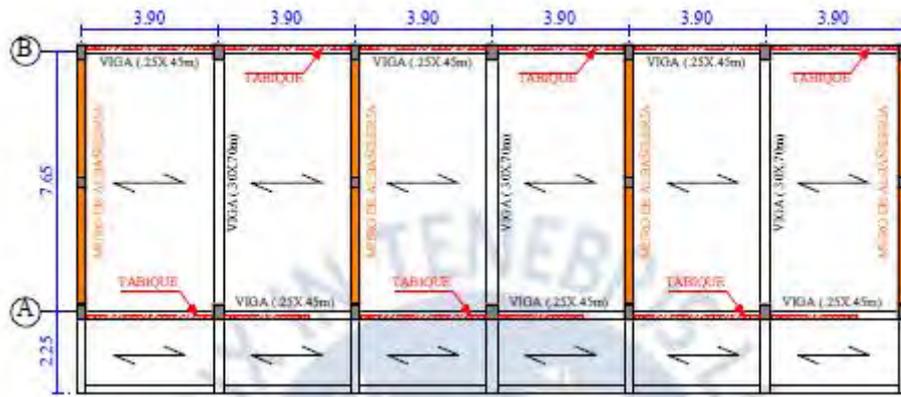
Planta estructural de los módulos típicos 780 Pre. (Fuente: Loa, 2017)
